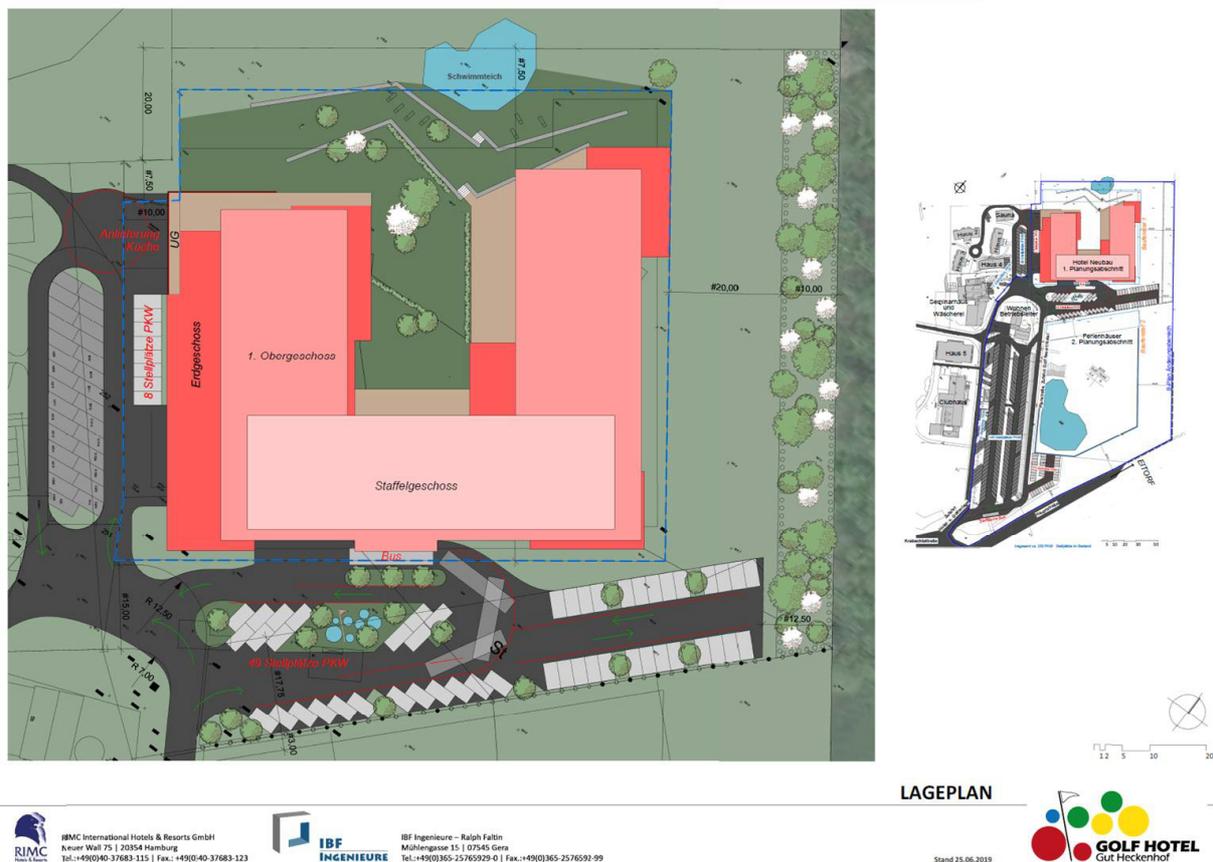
Lageplan des Hotel Neubaustagebaus im 1. Planungsabschnitt (GOLF HOTEL GUT HECKENHOF 2019).
